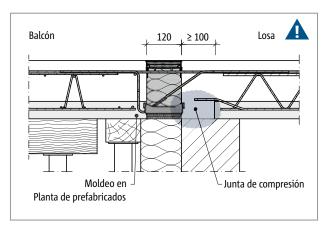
Schöck Isokorb® XT tipo K: Apoyo directo, instalación conjuntamente con placas prefabricadas (aquí: h ≤ 180 mm), junta de compresión del lado de la losa
